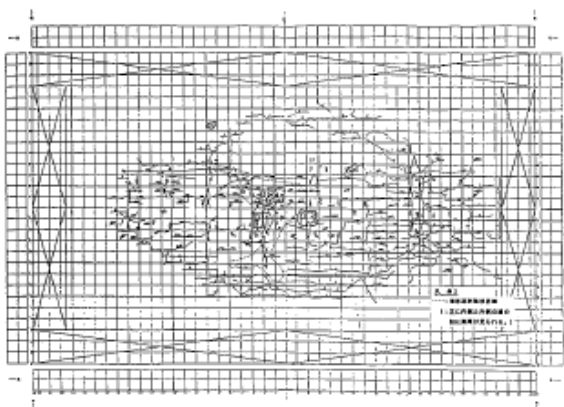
増厚後走行荷重によるひび割れ
